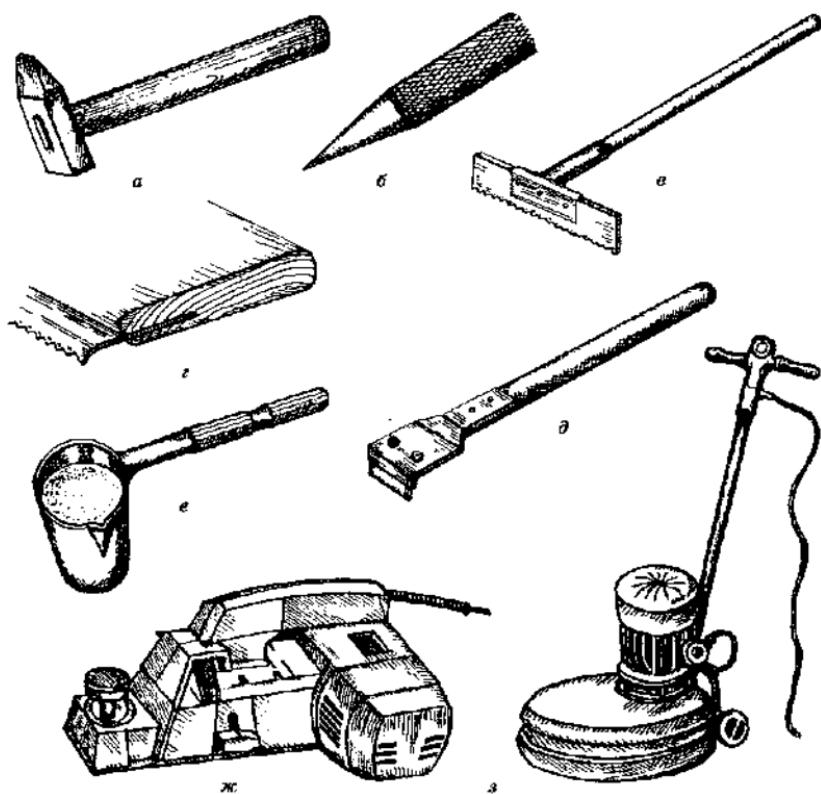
Инструменты для паркетных работ: а — паркетный молоток; б — добойник; в — гребенка; г, д — цили с короткой и длинной ручками; е — мерный черпак; ж — ручной электрический рубанок; з — полотерная машина
